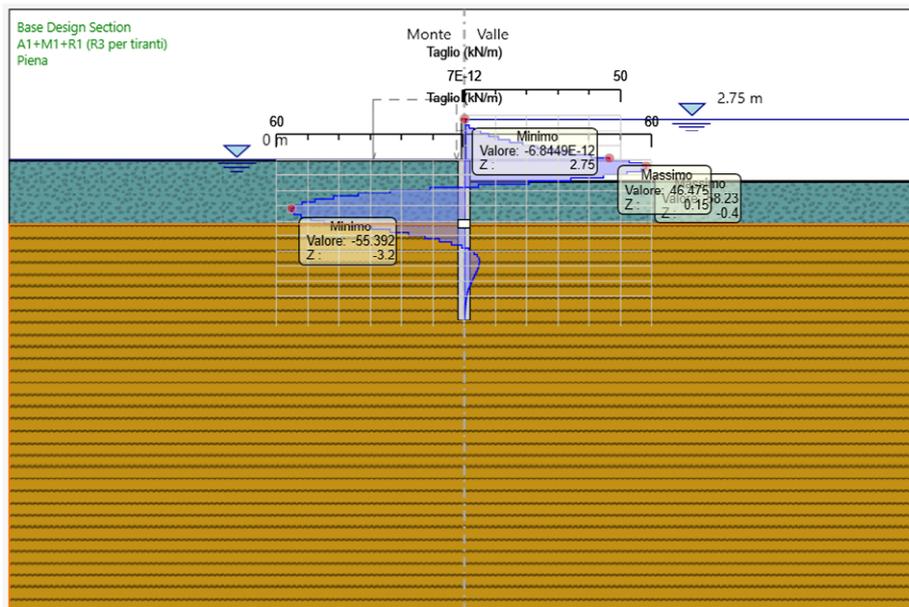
Opera protezione spondale. Fase 4: SLU A1+M1+R1 – Azione tagliante
